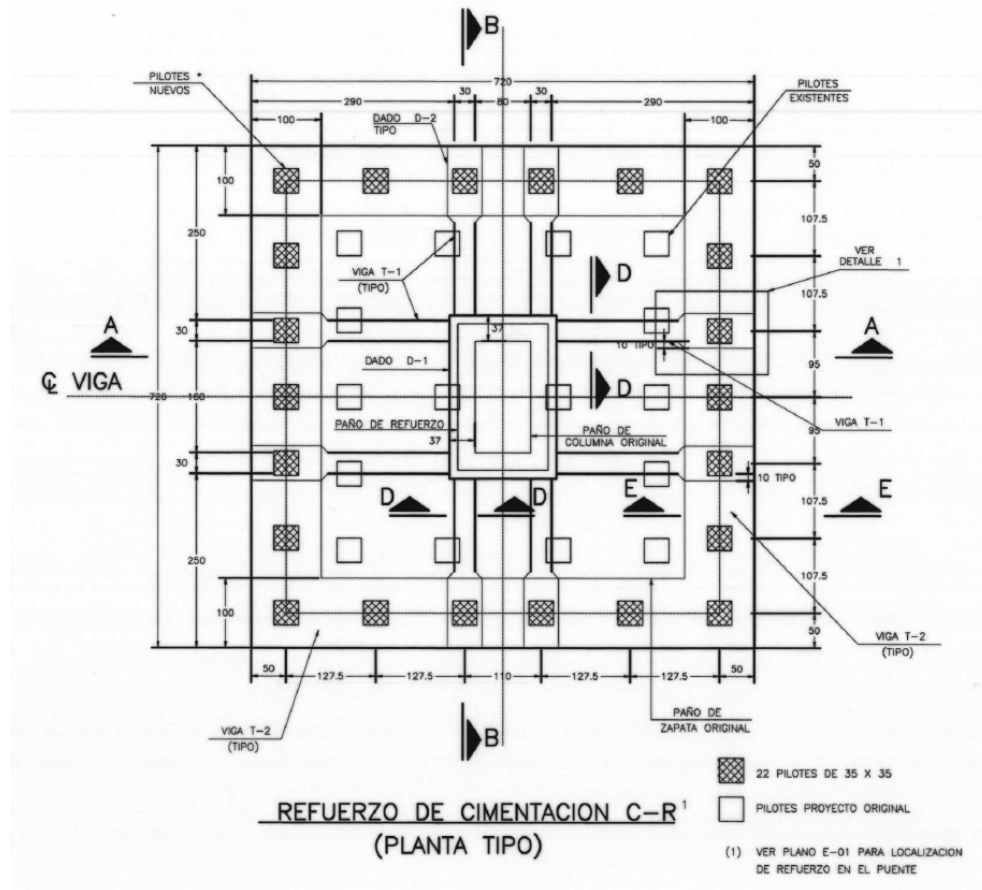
Cimentación típica de las pilas centrales del puente - Planta. Proyecto original y de actualización sísmica
